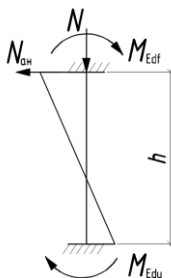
Определение усилия в анкере в уровне перекрытия от изгибающих моментов
